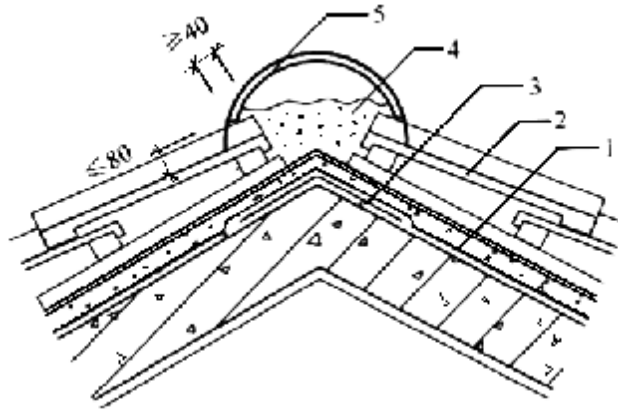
烧结瓦、混凝土瓦屋脊防水构造
